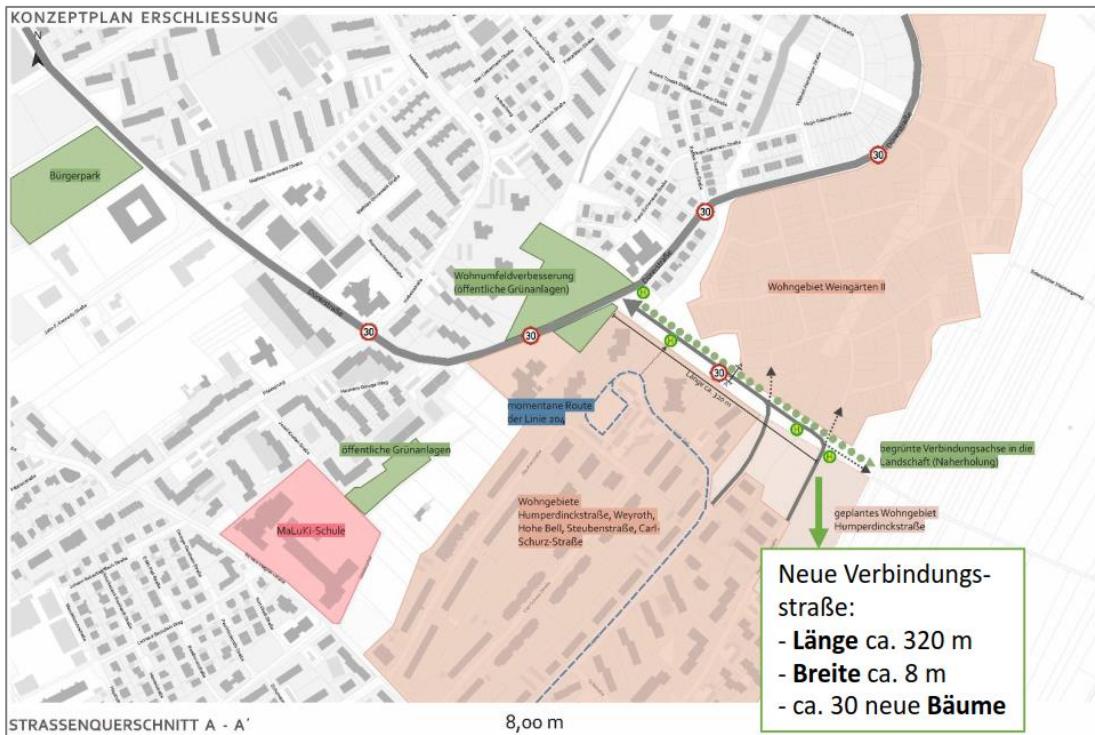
Geplante Straßenverbindung zur Dürerstraße
